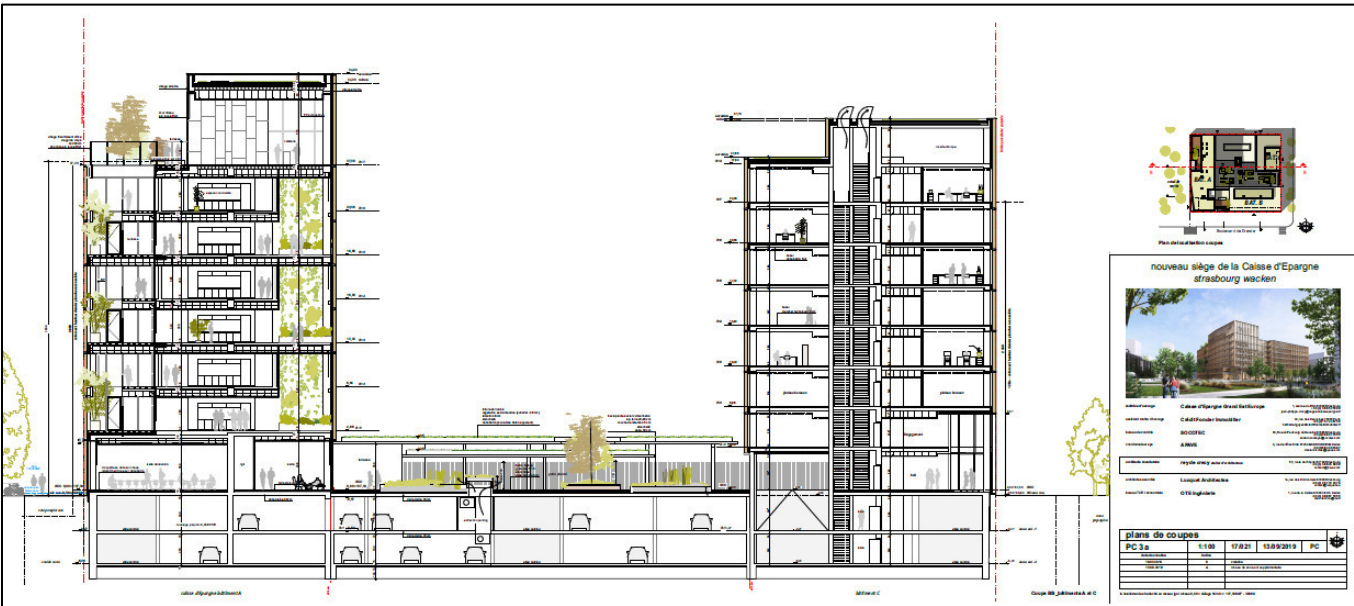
Plan en coupe des bâtiments A et C et des niveaux souterrains
